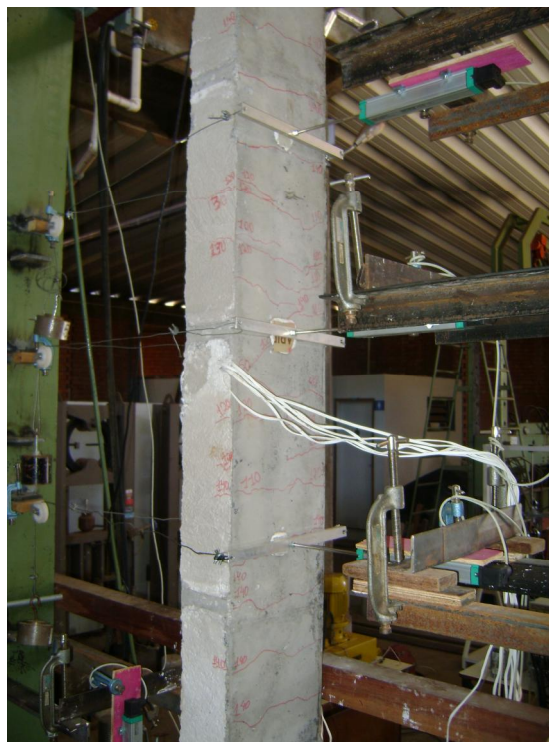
Fissuras do pilar PFN 50-2,5
